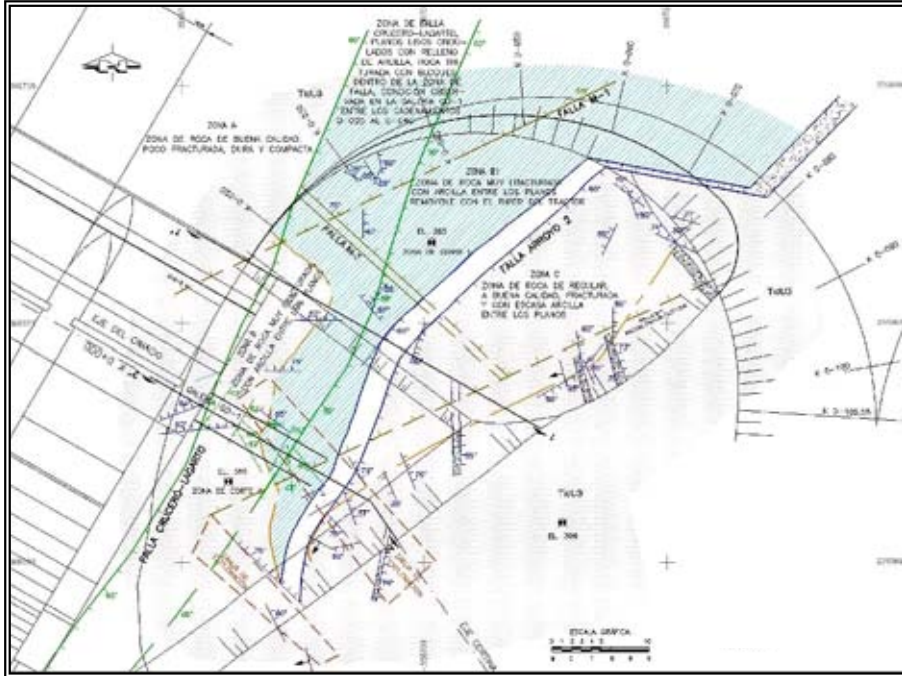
Planta geológica en las elevaciones 386 y 383 m.s.n.m. del muro alabeado.
